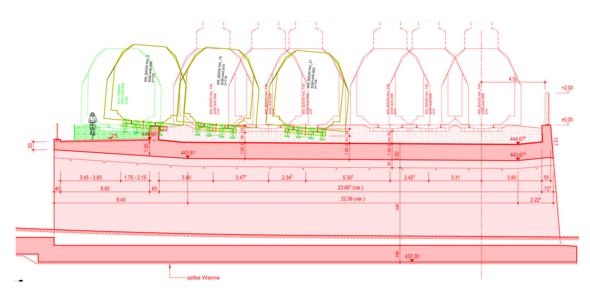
SU Faisswiesenstr., Längsschnitt.
